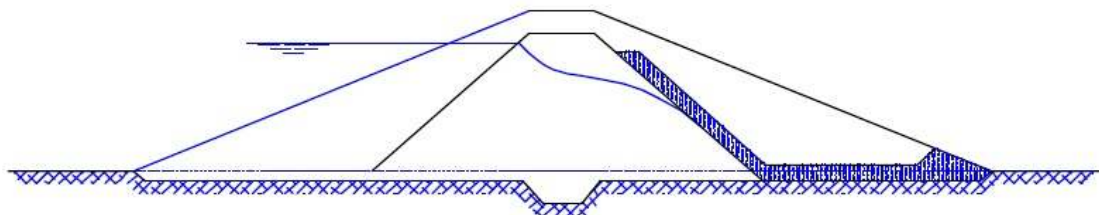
Exemplo de perfil tipo de terra homogênea e sistema de drenos horizontal (tapete drenante) e vertical (chaminé drenante) (Lança, 1997).
